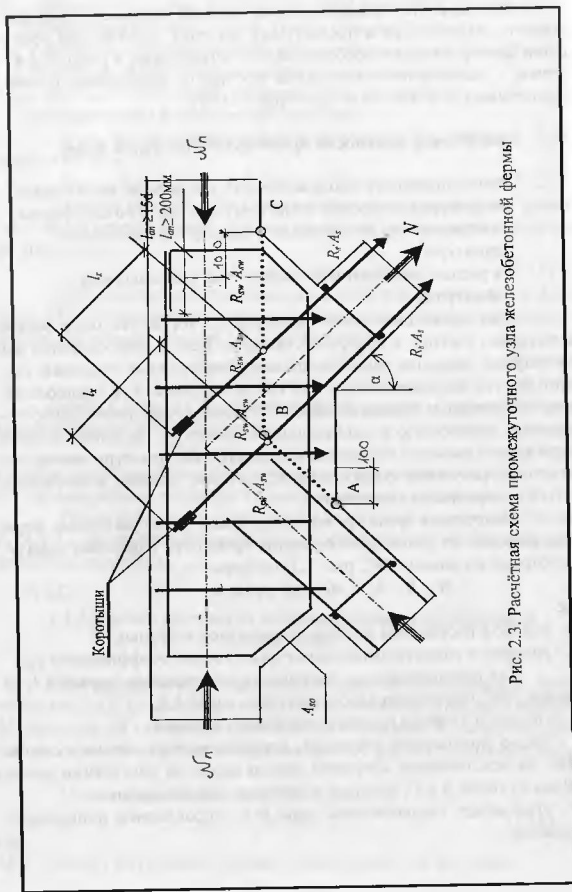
Расчётная схема промежуточного узла железобетонной фермы
